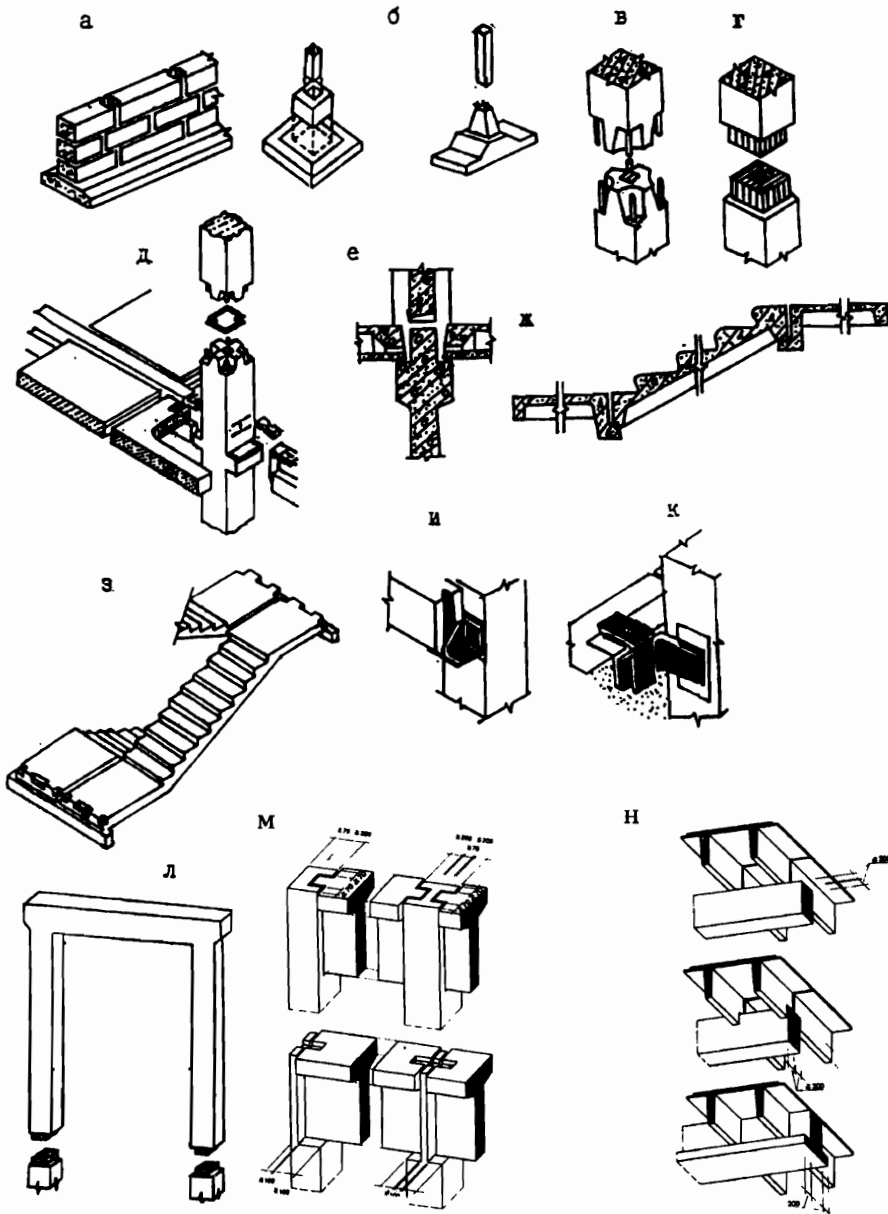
Основные стыки многоэтажных зданий: а - стеновых блоков подвала; б - колонн и стаканов или подколонников; в, г - колонн с колоннами; д - колонн и ригелей; е - стенок жесткости и перекрытий; ж, з - лестничных площадок и маршей; и, к - стеновых панелей и колонн; л - плоских рамных конструкций; м - балок с колоннами; н - плит перекрытия с ригелями
